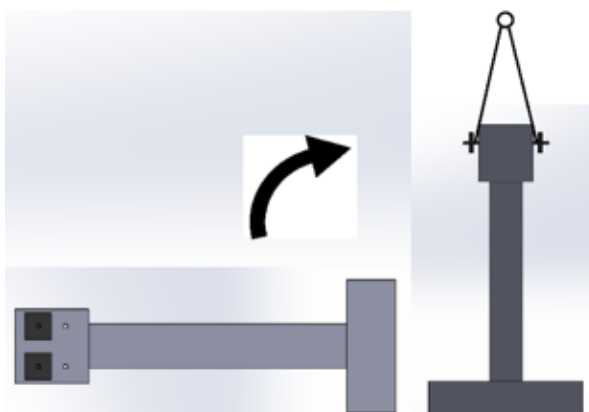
Basculement des colonnes : Position horizontale (coulage du béton) à verticale (test)
